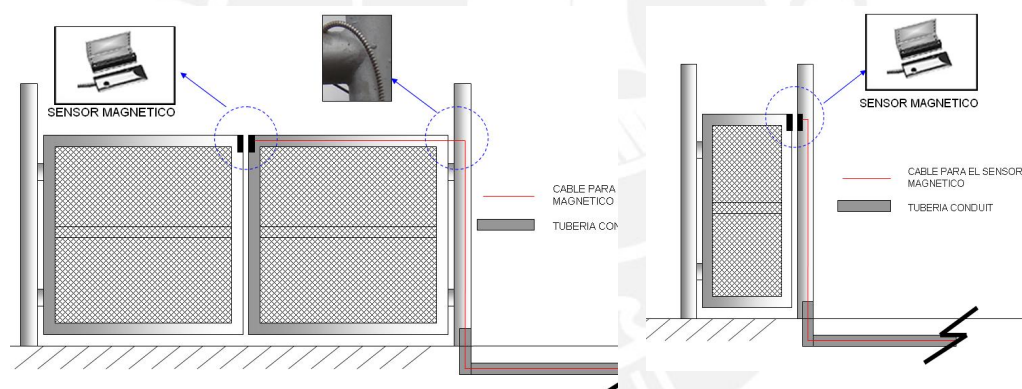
Izquierda.- Instalación de contactos magnéticos en puertas de doble hoja.-
